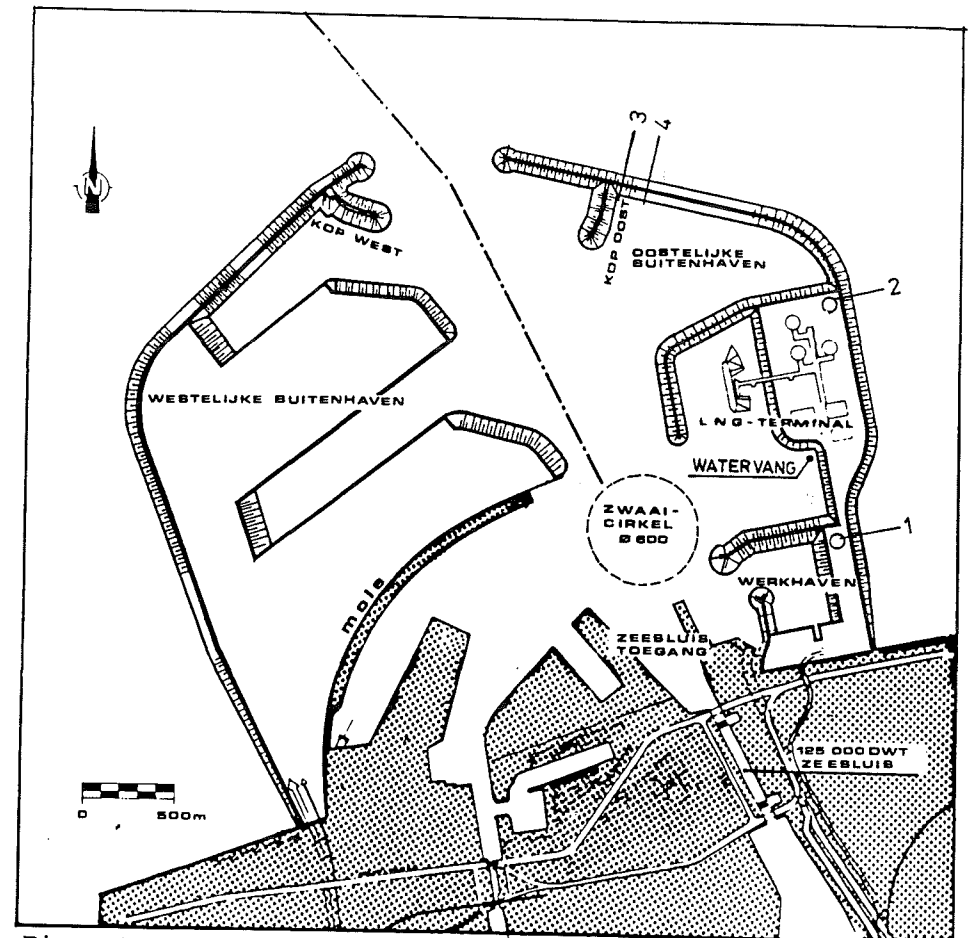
Algemeen plan van de buitenhaven te Zeebrugge (met aanduiding van de uitvoeringsplaatsen van de vier waterdrukmeetcampagnes)
